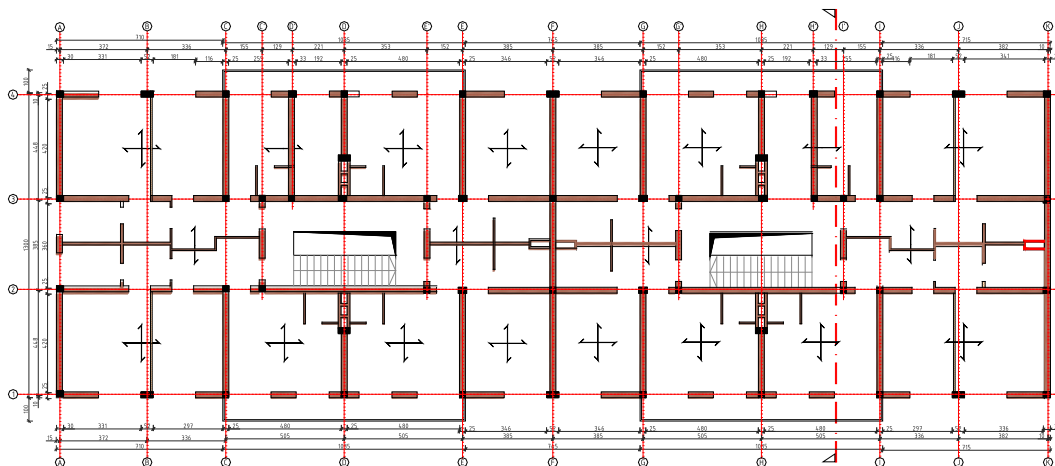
Planimetria e katit karakteristik të ndërtesës D3, ram BA me mure mbushëse
